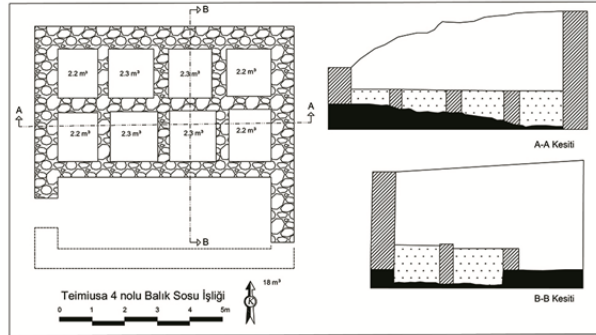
Teimiussa 4 Nolu İşlik Plan
